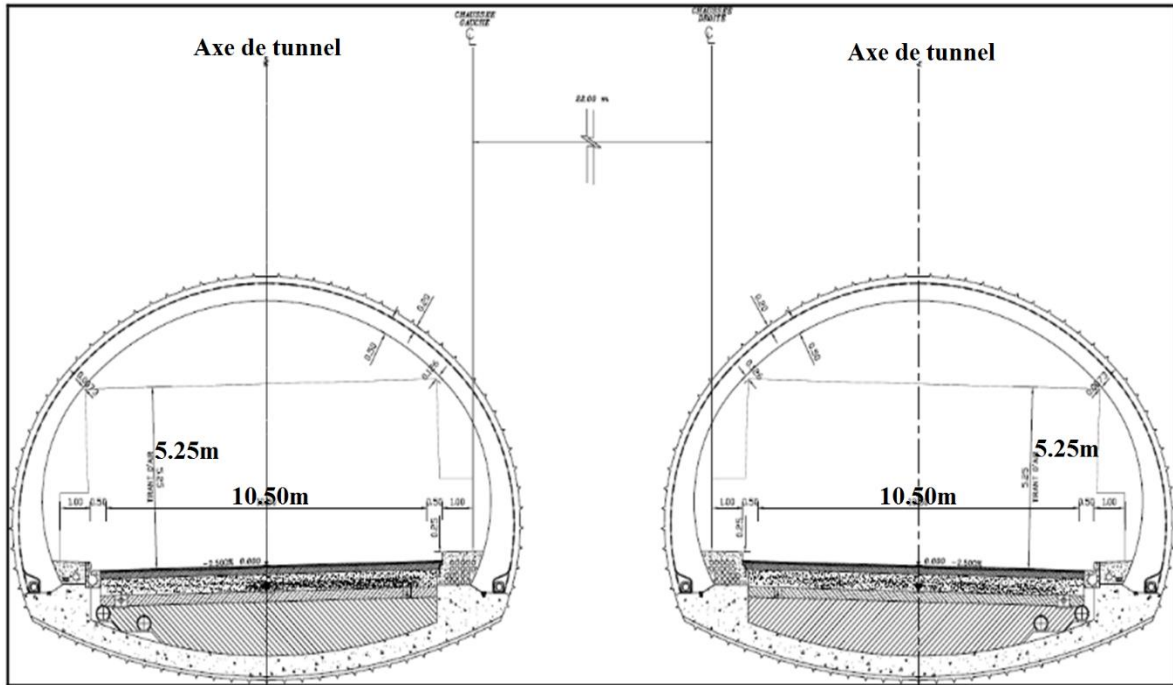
Coupe Transversale et Type de Tunnel T4.
